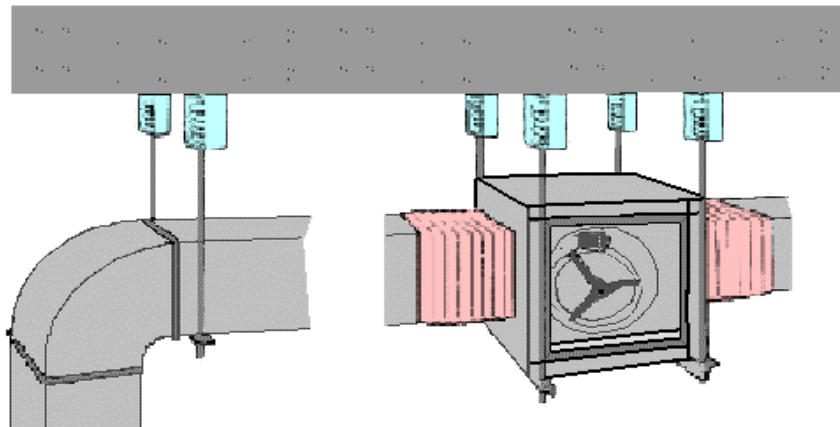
Detalle de colocación de amortiguadores para anclaje de máquina y dispositivo de separación entre máquina y conducto.
